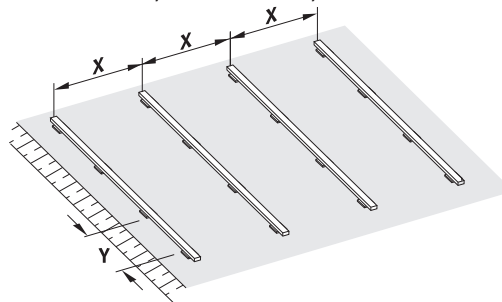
Укладка с резиновыми прокладками на бетонном полу
